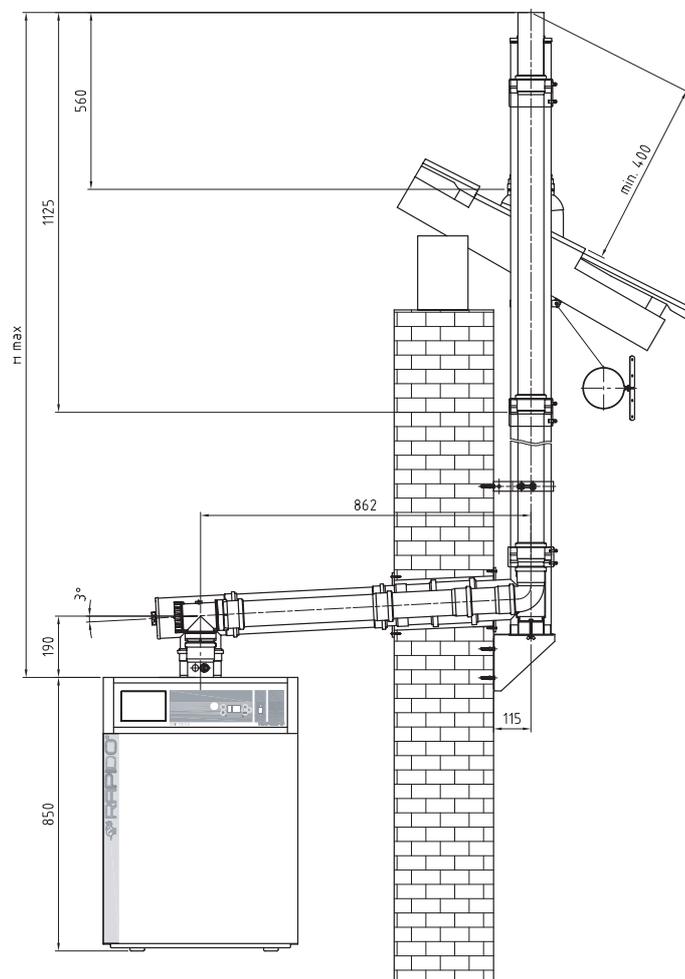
Raumluftunabhängiger vertikaler Außenwandanschluß mit Schrägdachdurchführung
